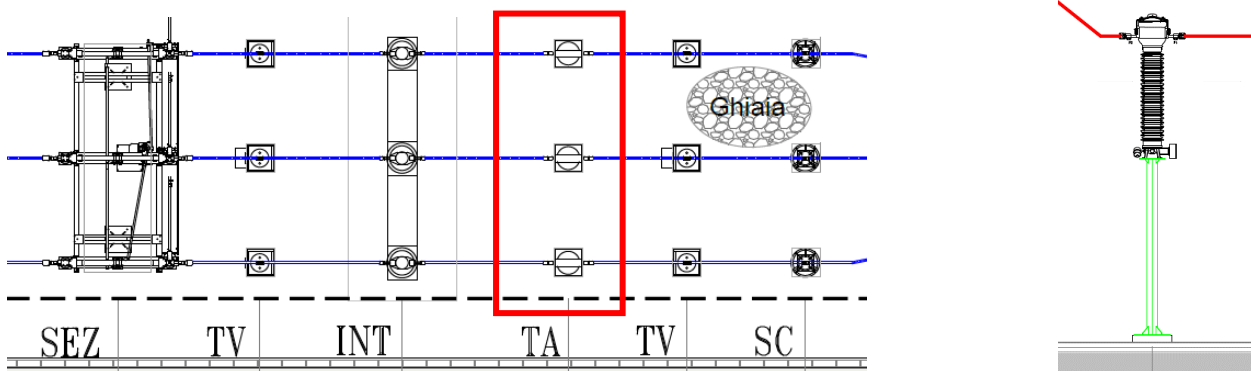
Tipico trasformatore di corrente – vista prospettica e planimetrica
